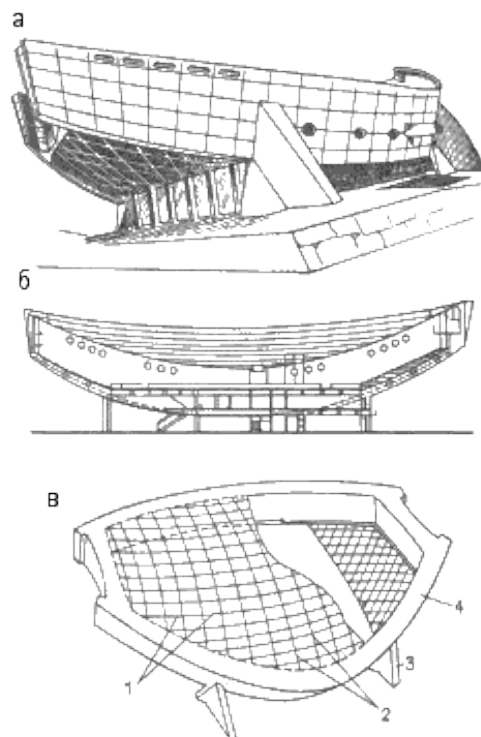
Спортивный центр в Ниигате (Япония): а - общий вид; б - продольный разрез; в- схема несущих конструкций: 1 - несущие ванты; 2 - стабилизирующие ванты; 3 - опоры; 4 - бортовой элемент
